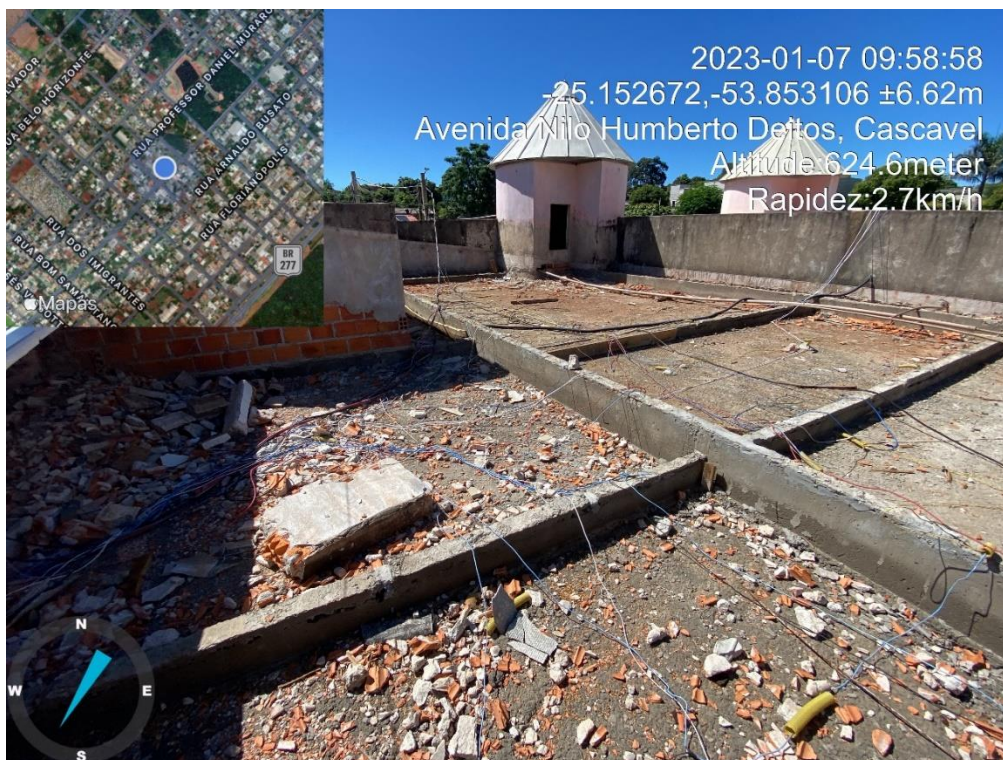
Vista da laje de cobertura. Detalhe instalação hidráulica sem nivelamento/travamento junto ao piso.
